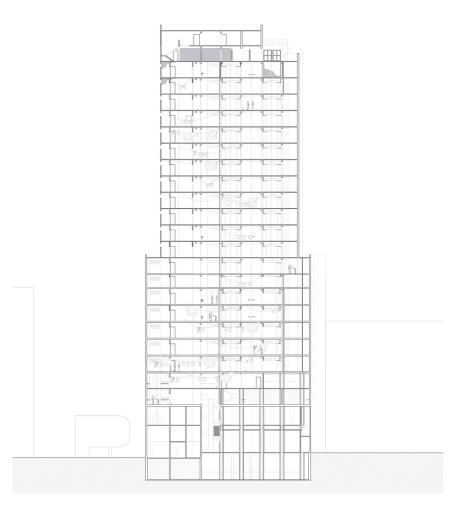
Corte Longitudianal edificio Prestes Maia Fuente: Elaboración propia
